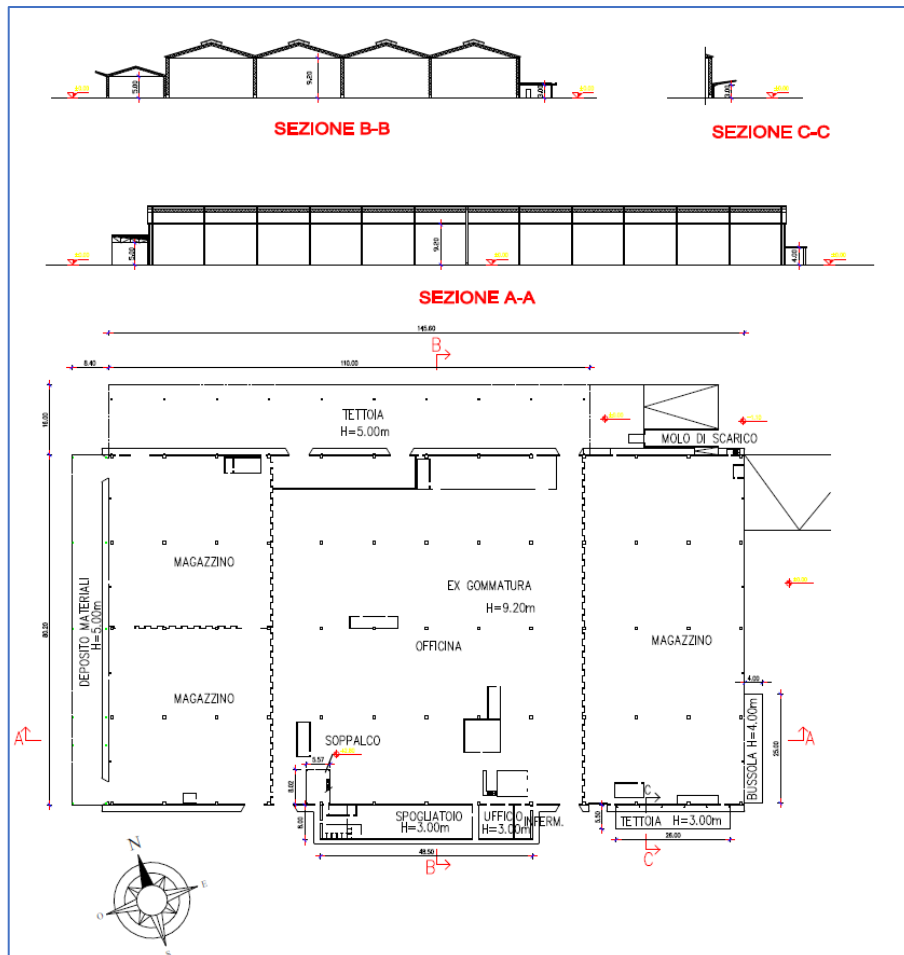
UMIA1b – Capannone ex Gommatura - Planimetria e sezioni
